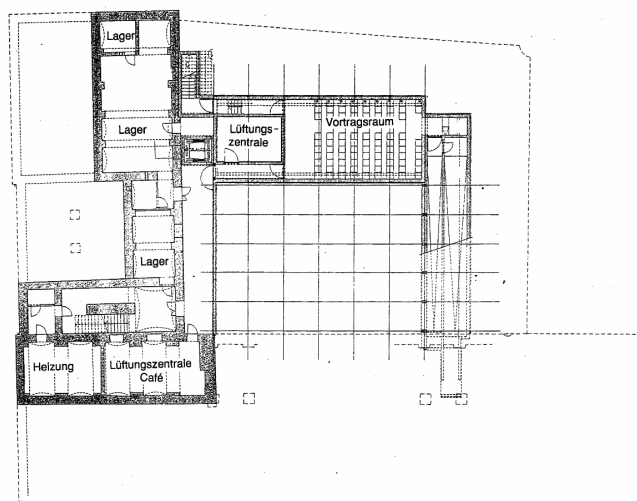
Kunsthalle Krems, Grundriss UG.
